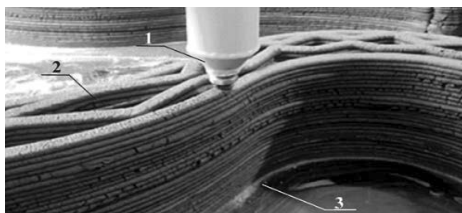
Изготовление конструкций послойным экструдированием: 1 – сопло (экструдер); 2 – изготавливаемая конструкция; 3 – основание.
